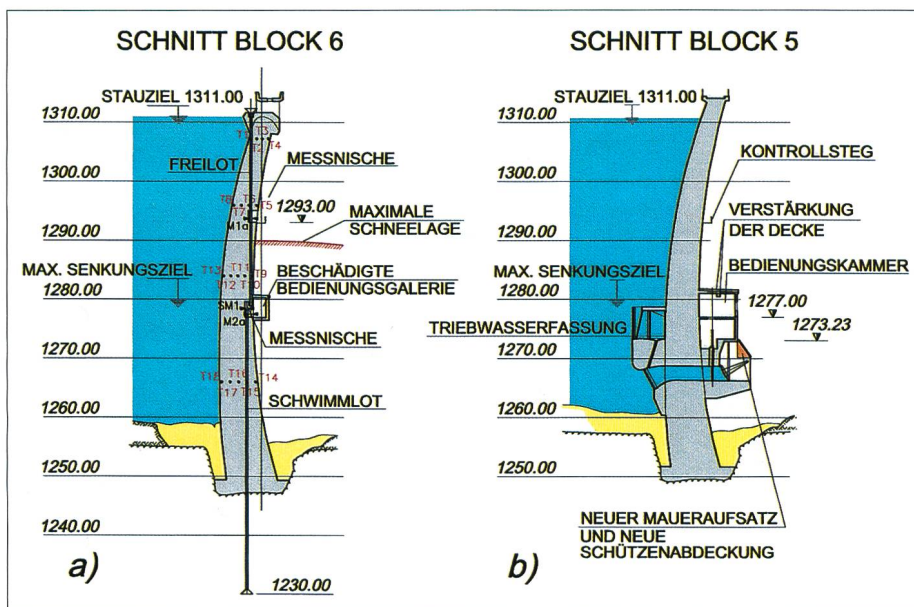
Vertikalschnitte der Bogenmauer: a) Zentraler Block mit vorhandenen Messeinrichtungen und b) Block Nr. 5 mit Grundablassöffnungen.
